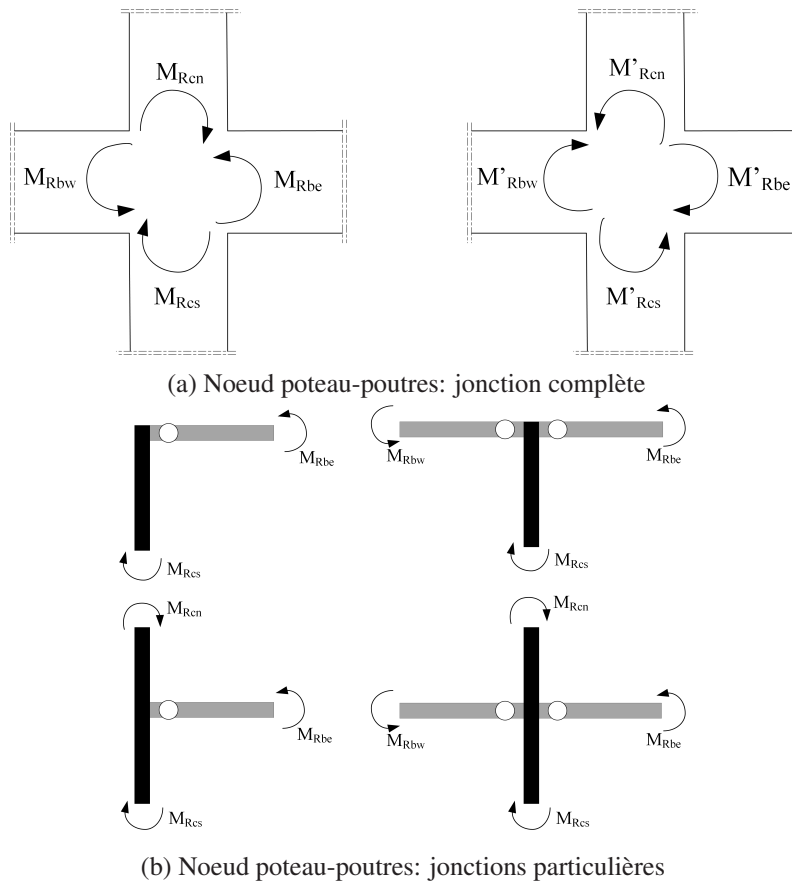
Dimensionnement d'un nœud poutre-poteau
